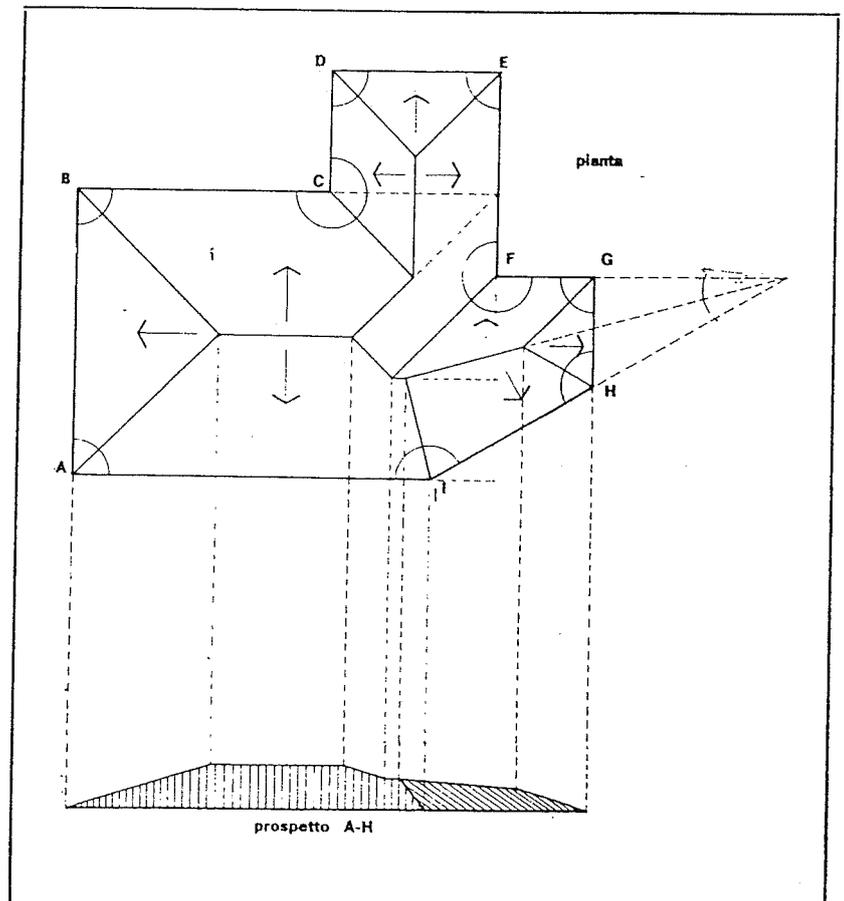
Tracciamento di copertura a quattro falde con linee di gronda non parallele. Pianta e prospetto
